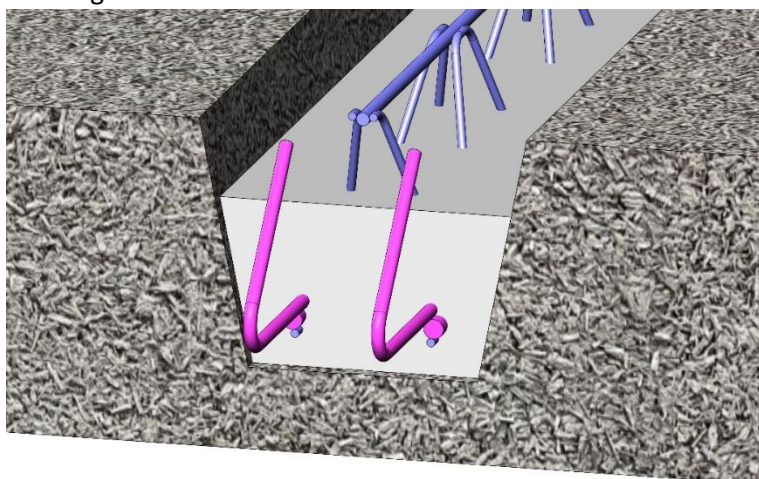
Positionnement standard des aciers d'ancrage à l'appui dans les prédalles DS1
